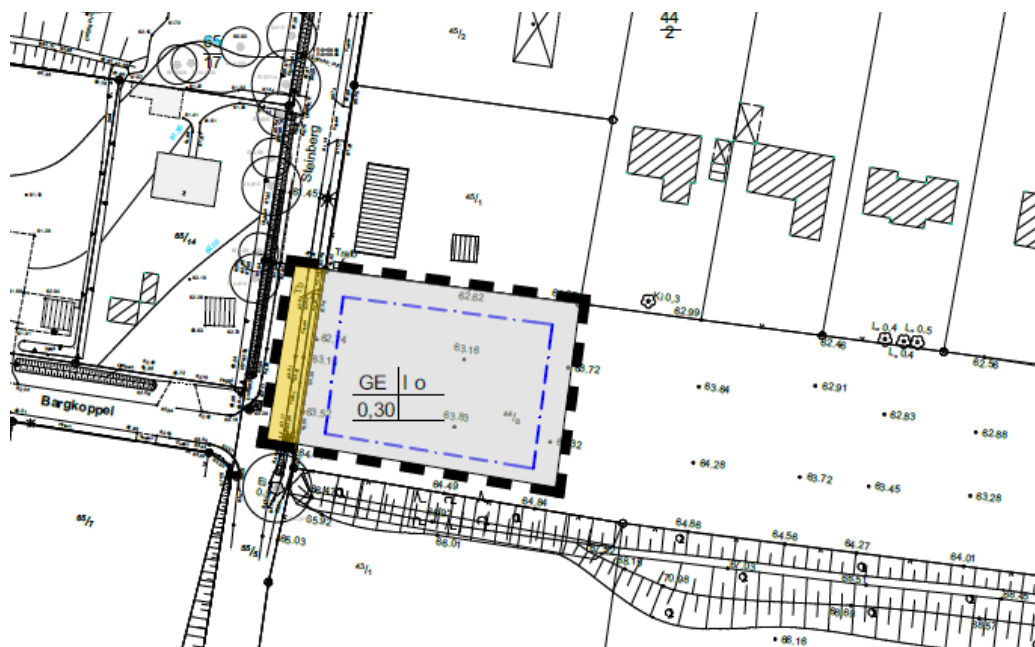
Planung, B-Plan 10 8. Änderung (Architekt+Planer Hans-Jörg Johannsen, 2020).
